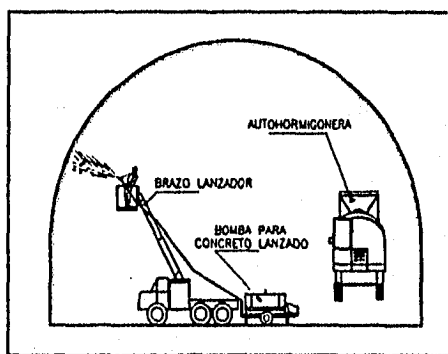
Aplicación de concreto lanzado vía húmeda.
